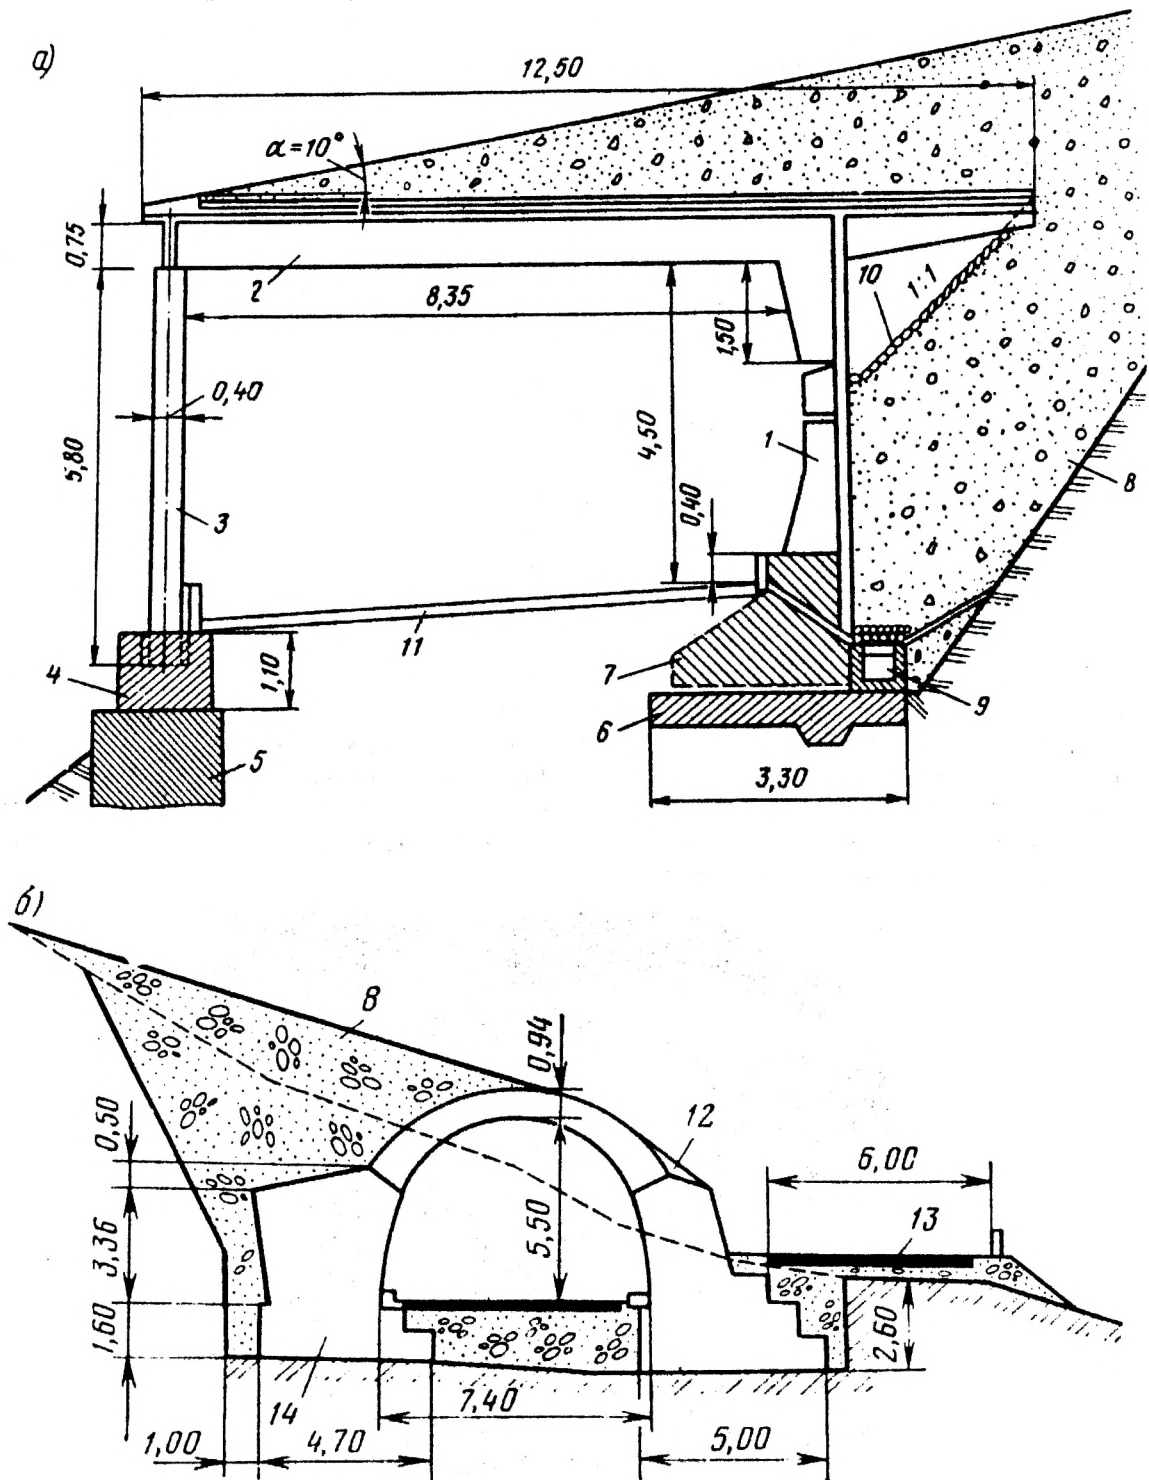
Конструкции противолавинных галерей: а – балочная консольная; б – арочная; 1 – стойка верховой опоры; 2 – железобетонная балка; 3 – вертикальная или наклонная стойка; 4 – горизонтальная опорная балка; 5 – фундаментная подушка; 6 – фундаментная плита; 7 – фундамент верховых опор; 8 – засыпка; 9 – дренажный лоток; 10 – мощение; 11 – бетонное покрытие; 12 – тощий бетон; 13 – летний путь; 14 – устой галереи
